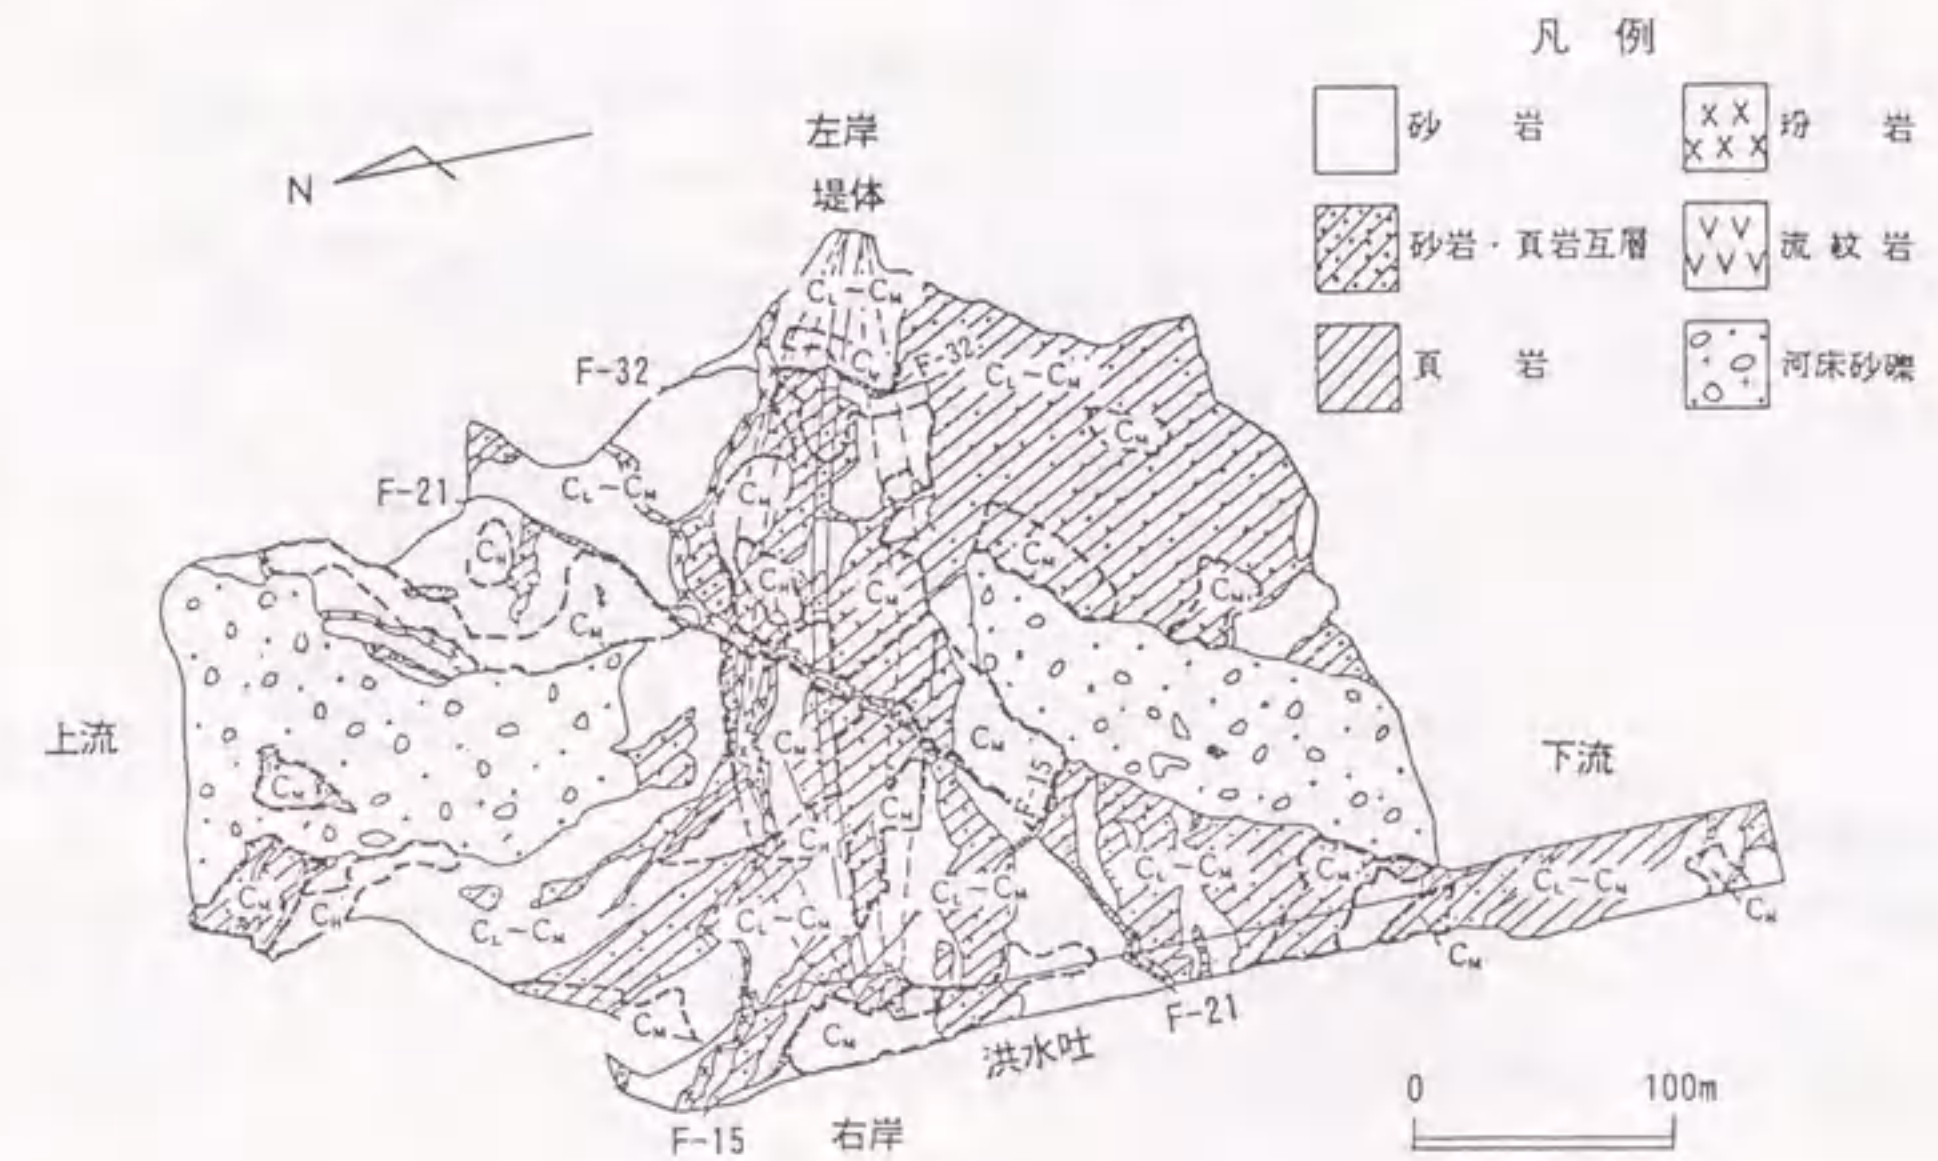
ダムサイトの地質および岩盤等級分類平面図
